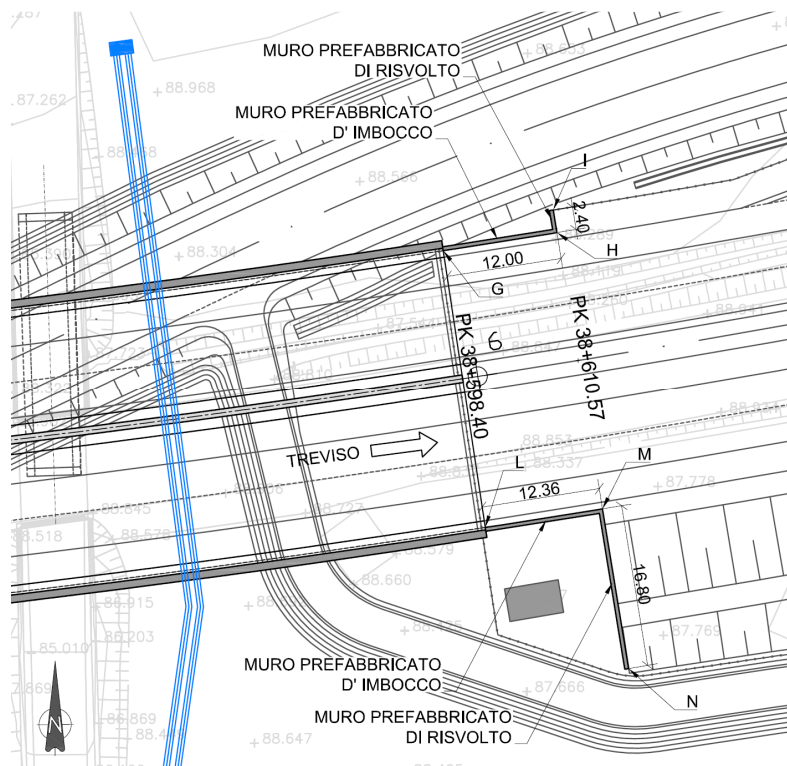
planimetria di tracciamento imbocco lato Treviso.
